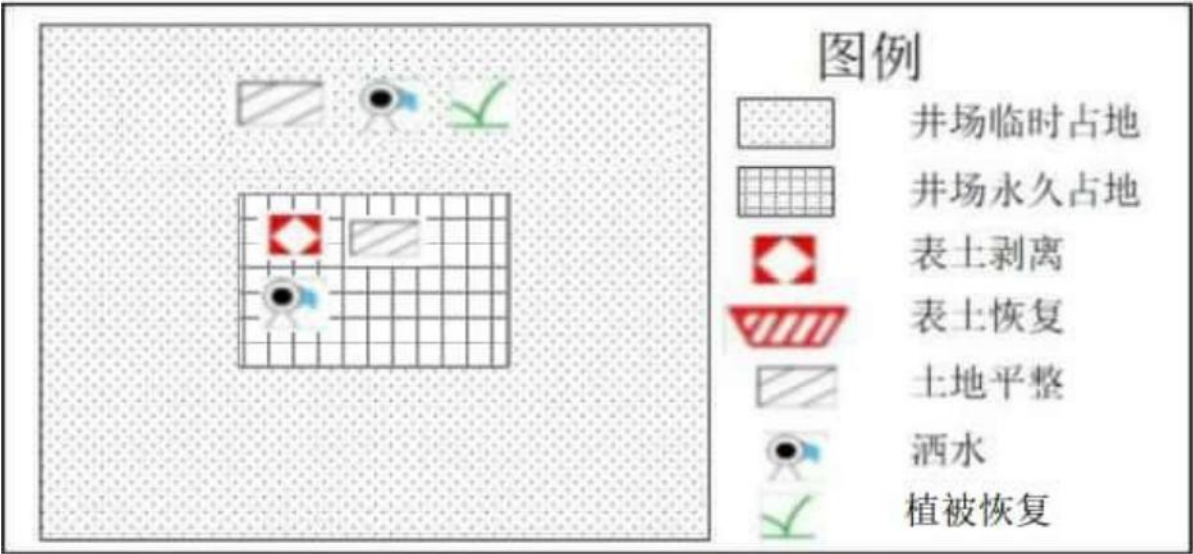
钻井井场典型生态保护措施平面布置示意图
